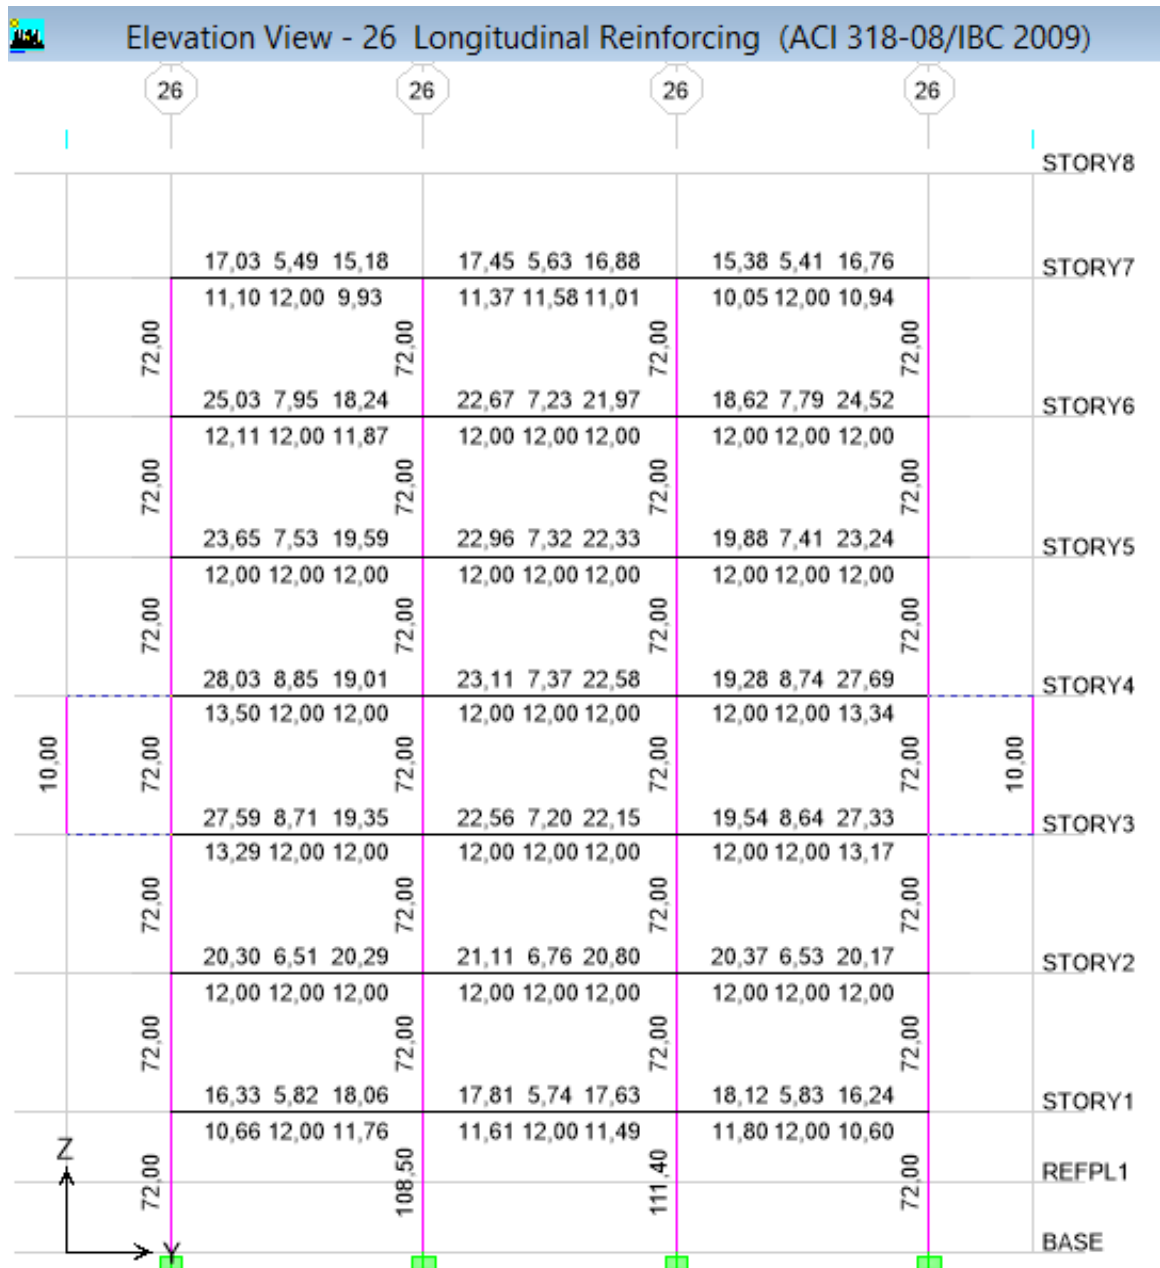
Acero en Vigas y Columnas en el Pórtico 26 – Hospitalización 2- (CEC-2002)
